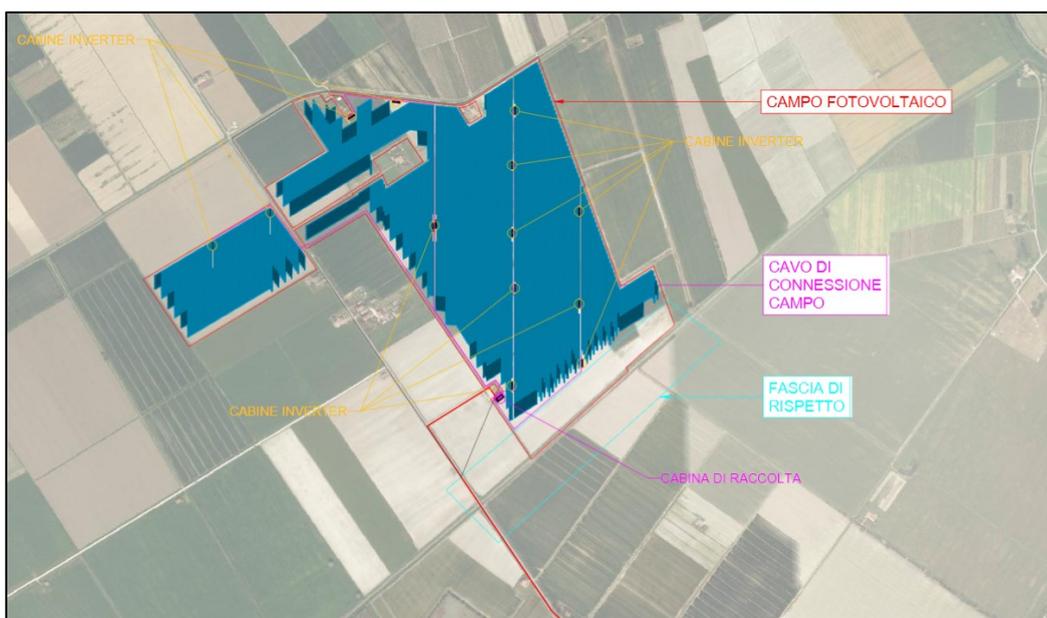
Stralcio della TAV.2.1 Layout impianto fotovoltaico su ortofoto
